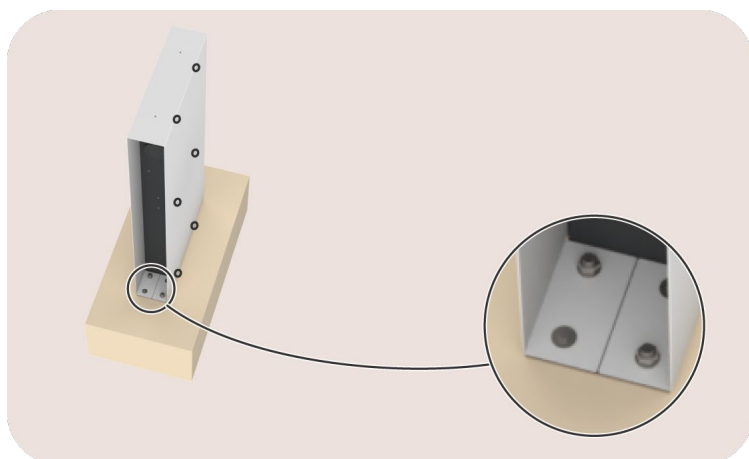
Vue sur les boulons qui maintiennent la plaque arrière et la plaque de sol.
